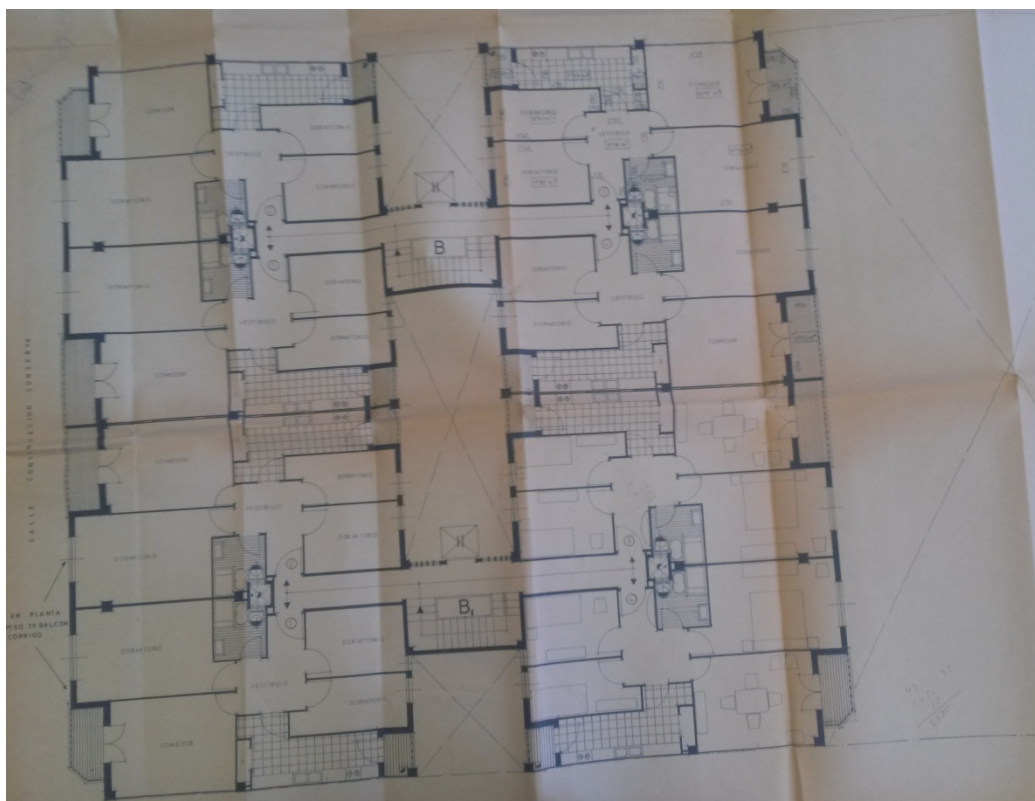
Plano planta pisos 2 a 7 zona interior.
